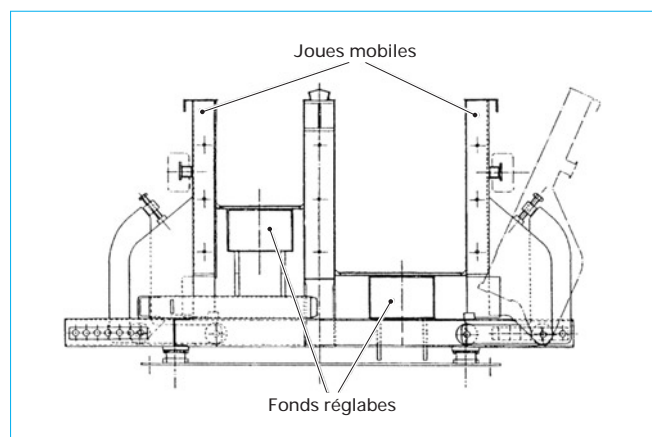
Coupe d'un moule double réglable pour poutres ou poteaux
